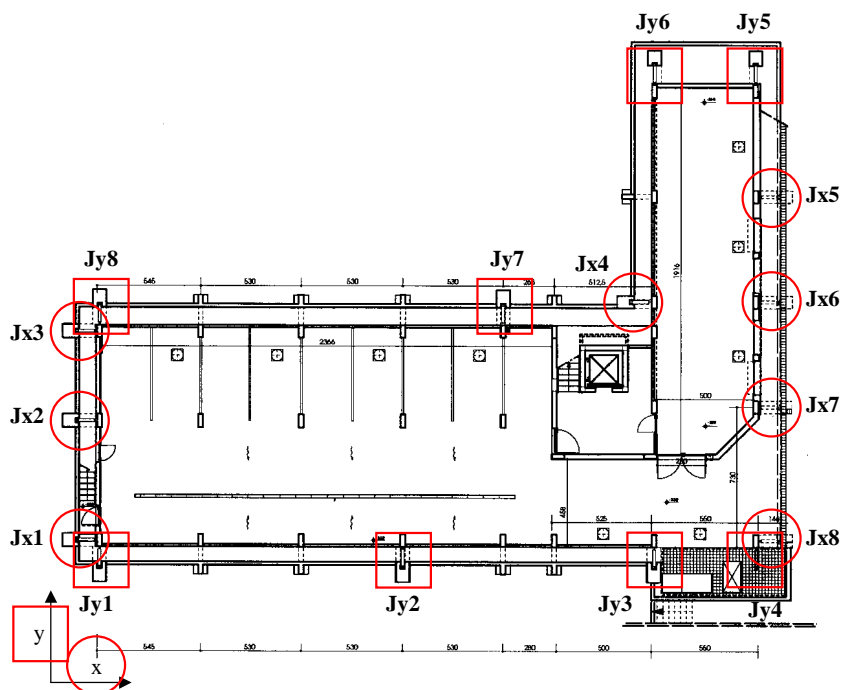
Pianta strutturale arrecante la collocazione dei dispositivi siliconici.
